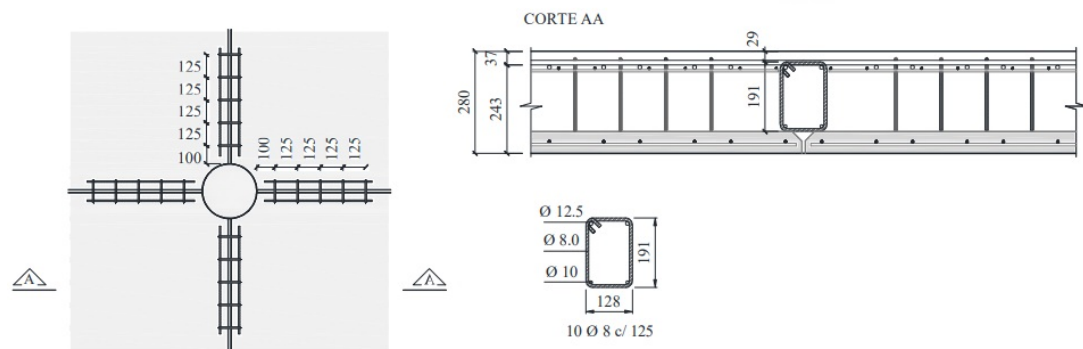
Armadura de cisalhamento das lajes SS1, SS2, BD3 e BD4 (dimensões em mm) (fonte: Nicácio (2018))
